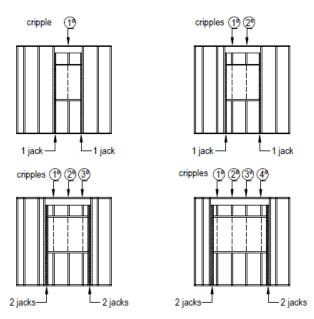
Detalles de Refuerzo para Dintel. Fuente: (ConsulSteel, 2014).
